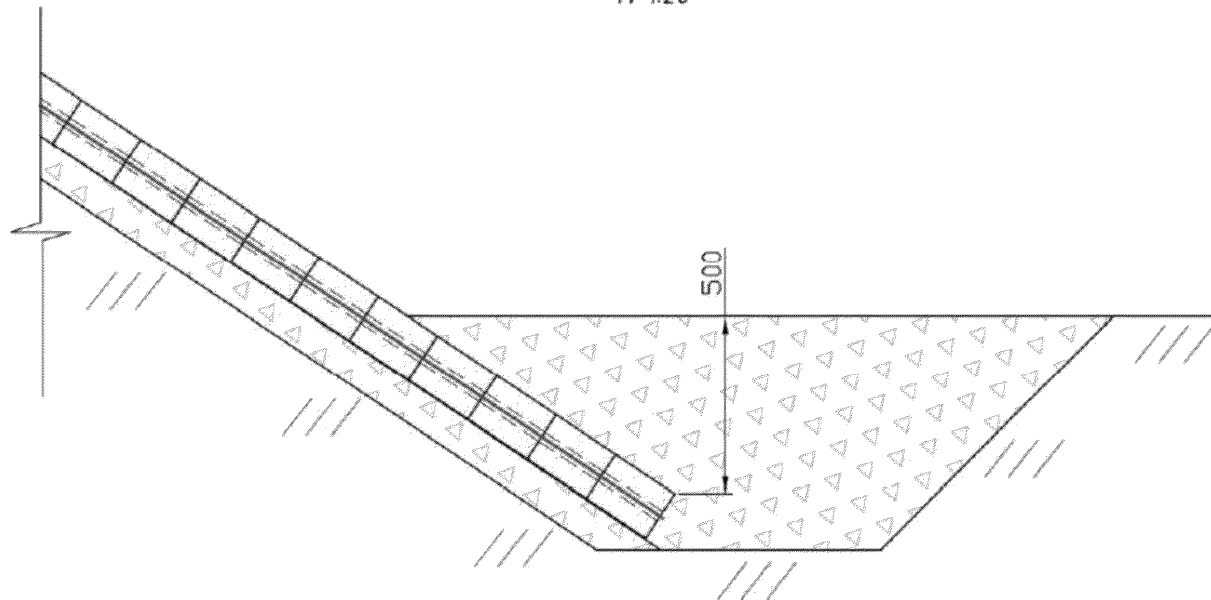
Возможная конструкция закрепления подошвы откоса
